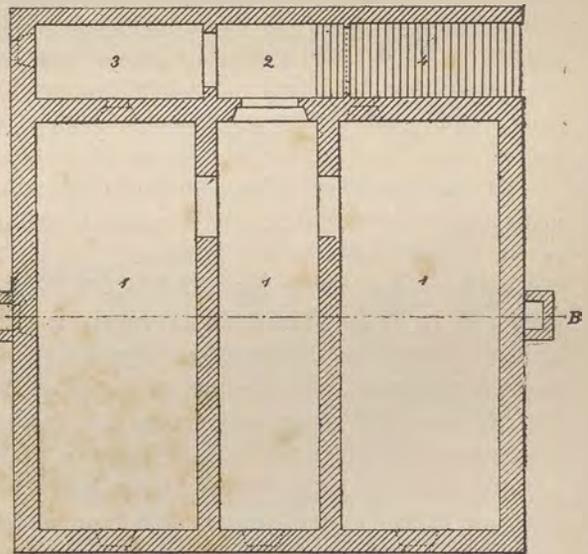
Cantine Laborel-Melini: Pianta dei sotterranei (cantine). — 1. 1. 1. cantina di conserva; 2. ingresso; 3. piccola cantina; 4. scala di accesso
